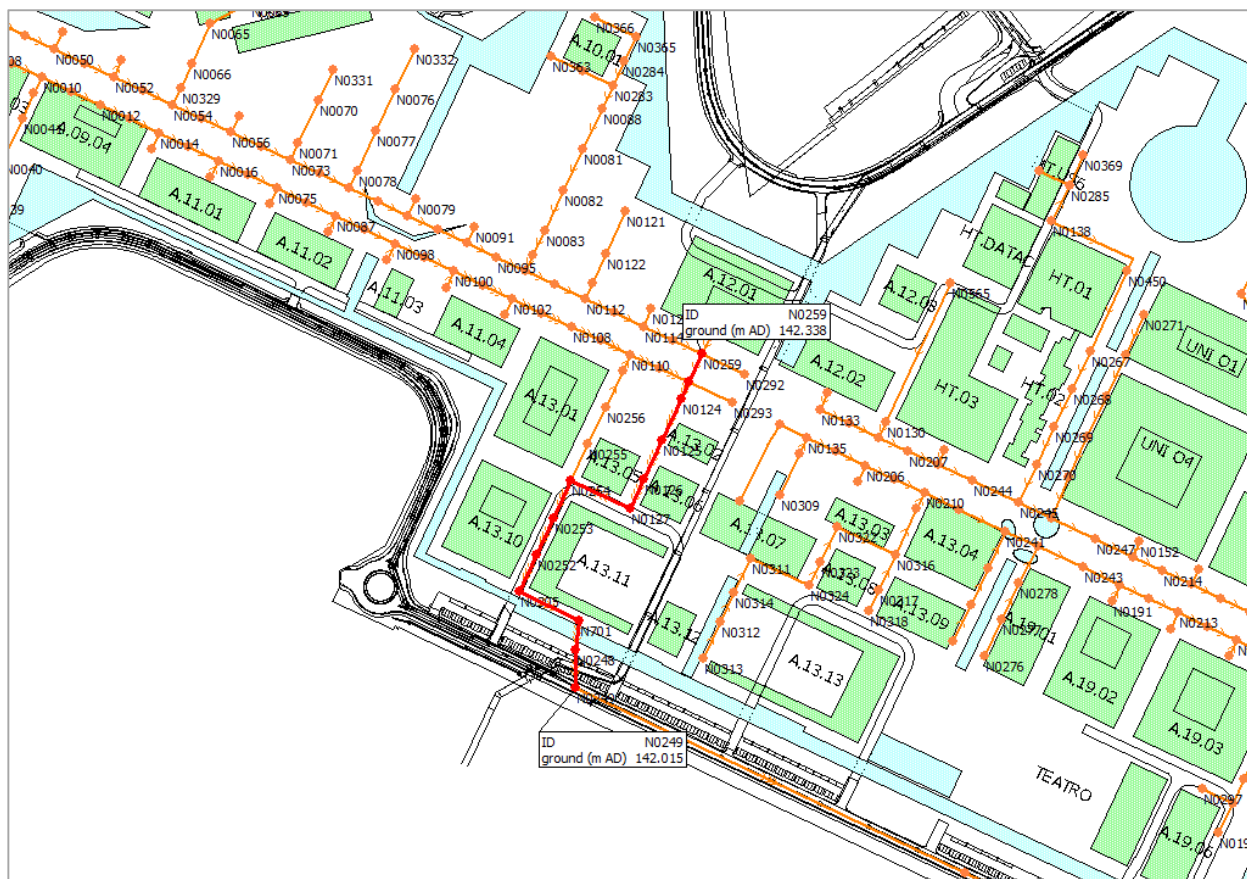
Stralcio planimetrico del tratto di profilo sopra riportato (in rosso i condotti selezionati)
